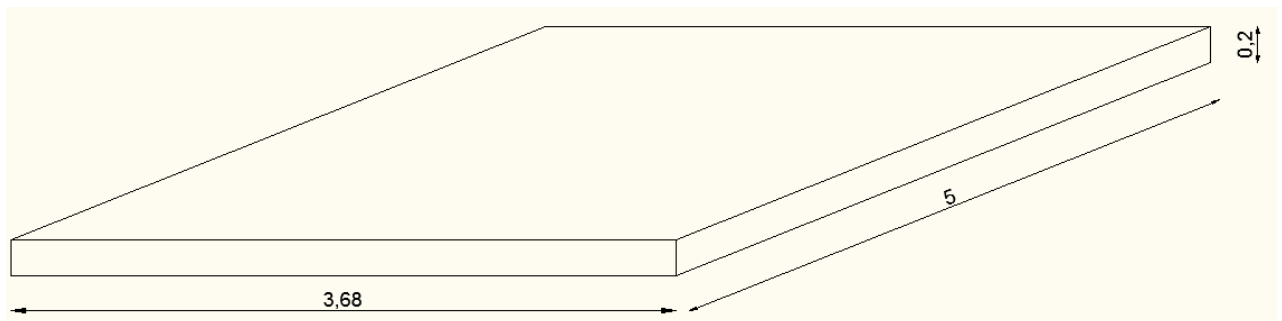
Vista 3D losa de hormigón pasillo entreplanta
